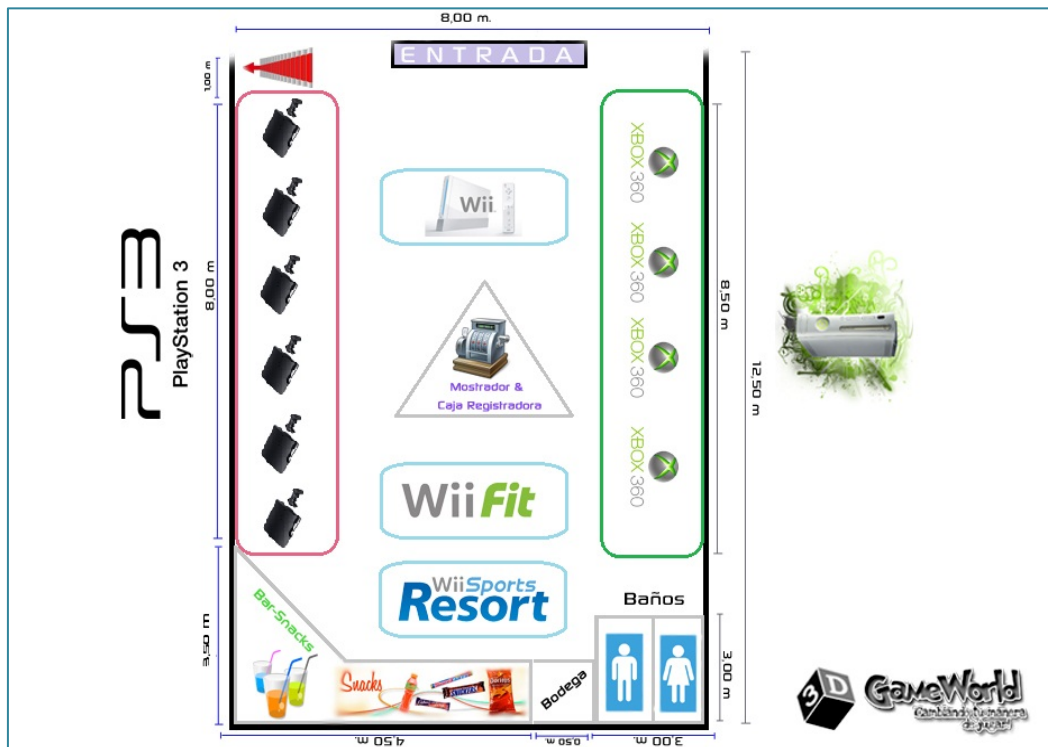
Plano Planta Baja 3D GAMEWORLD
